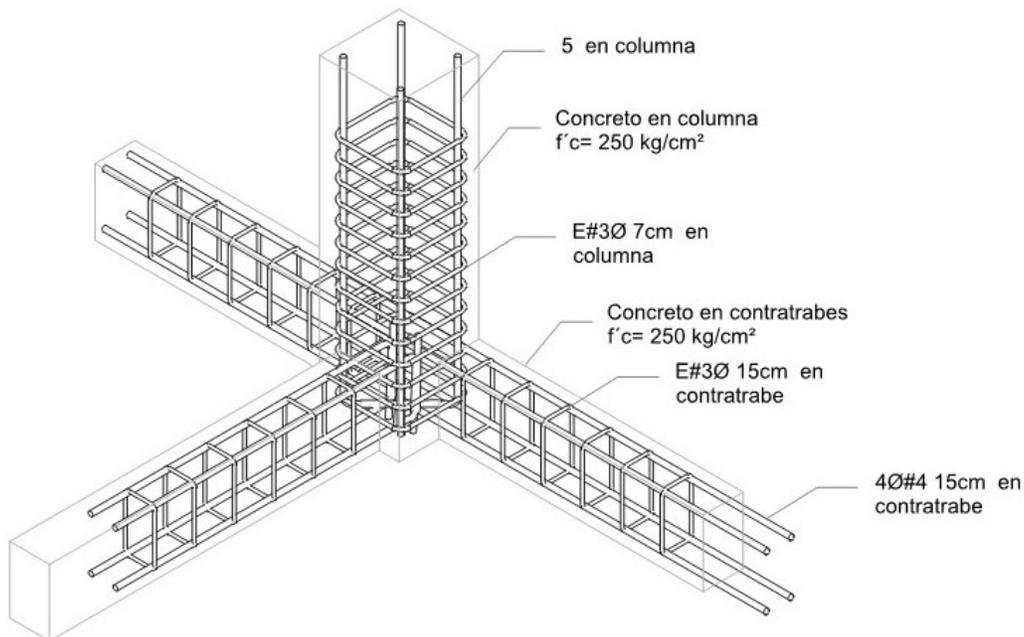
Detalle de columna / Fuente: Elaboración modificada de Bibliocad
